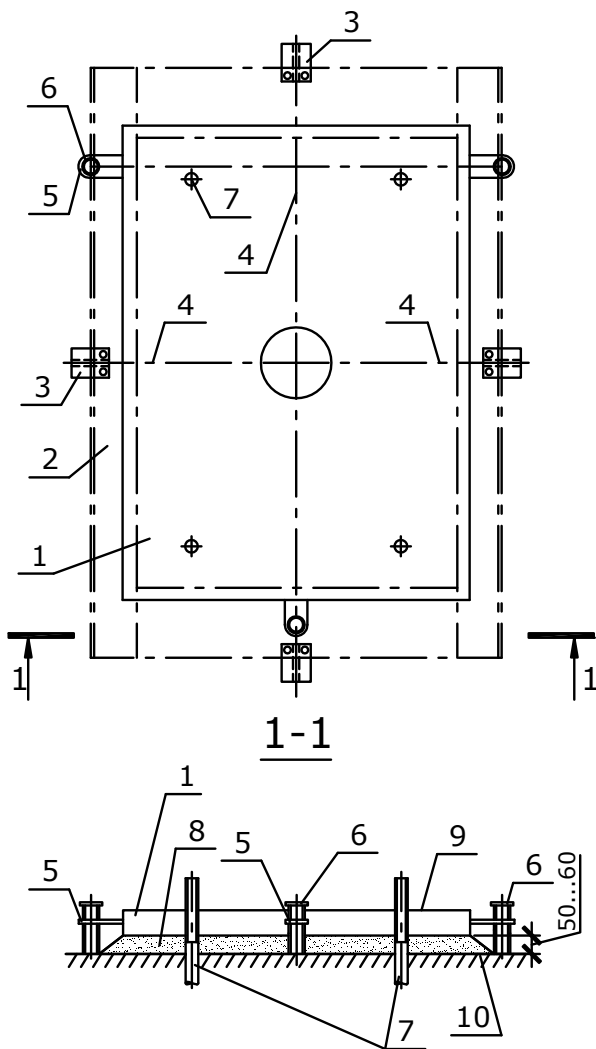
Установка опорной плиты с помощью выверочных винтов:
